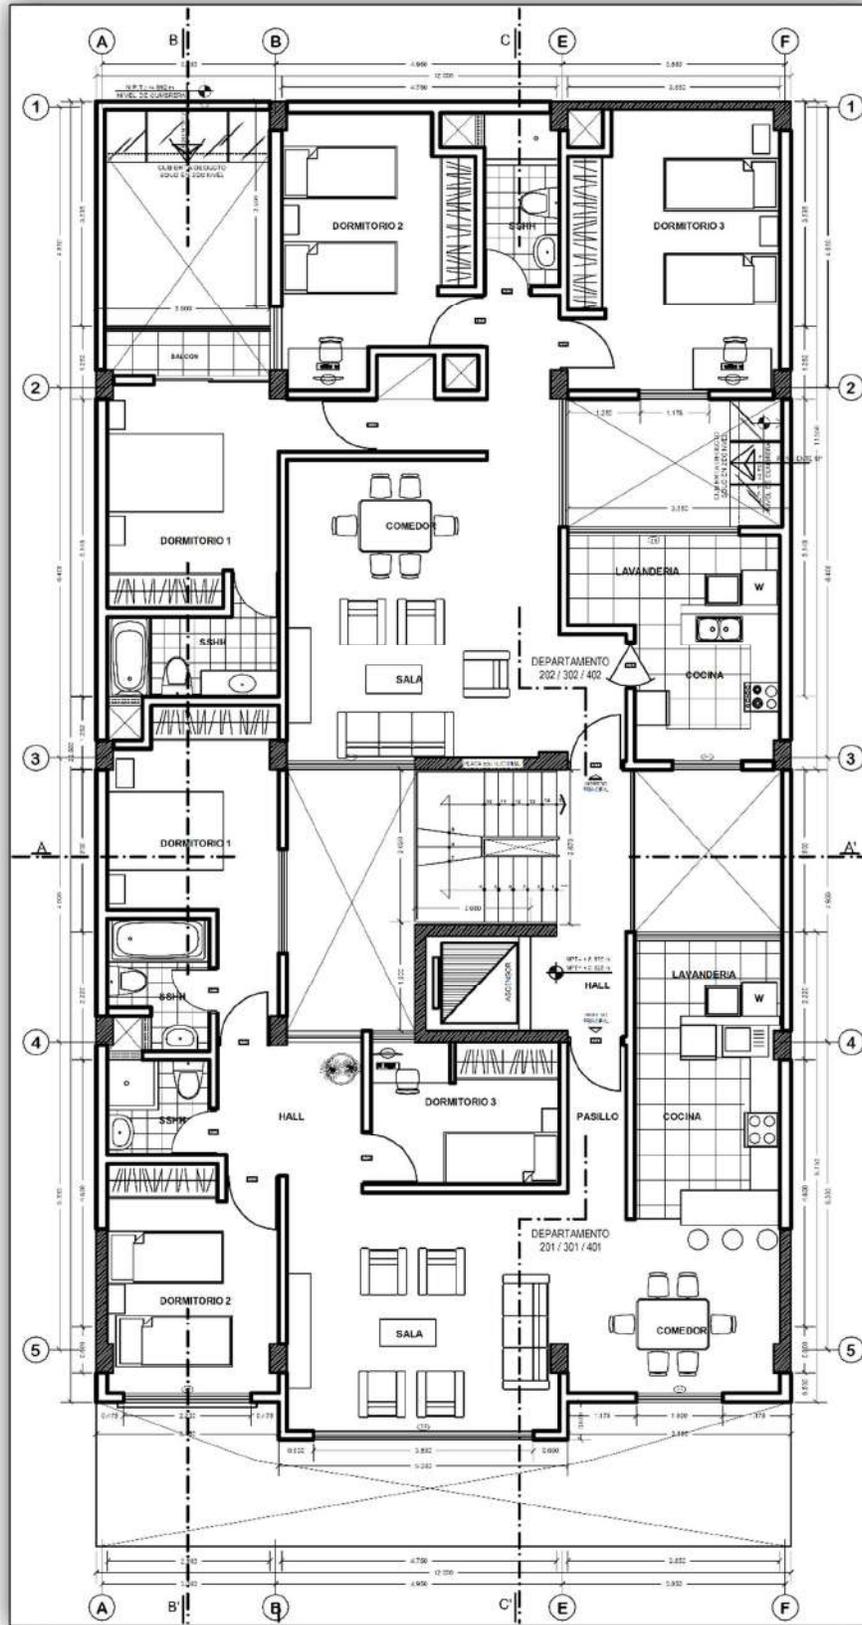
Planta 2^{do} al 4^{to} Nivel
